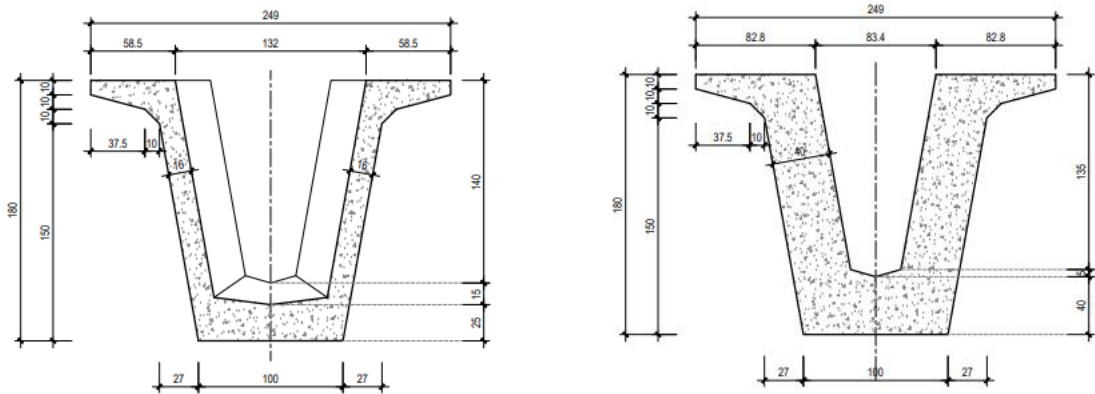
Sezione trasversale trave in c.a.p. sezione corrente ed in appoggio
